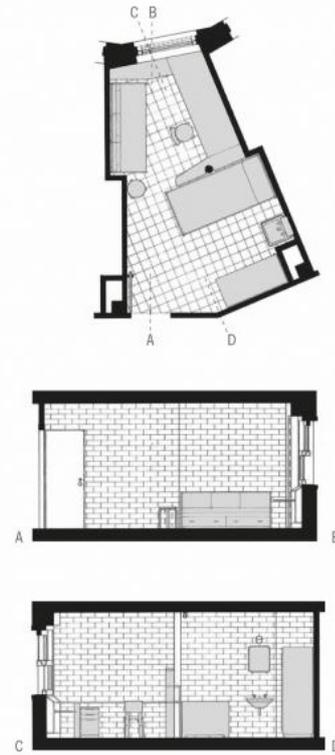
Plan und Schnitte Baker House, Alvar Aalto, Cambridge (MA) 1949
